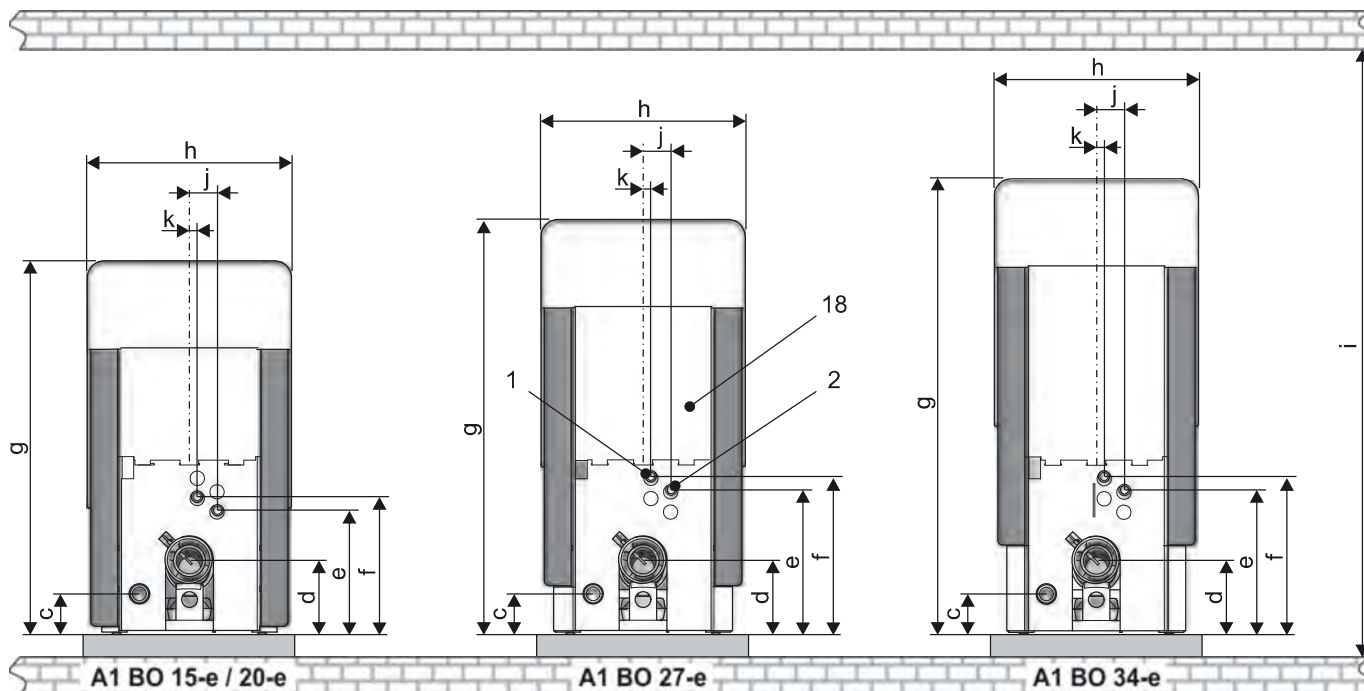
Dimensions et cotes de raccordement - vue arrière (légende voir tab. 4-1)
